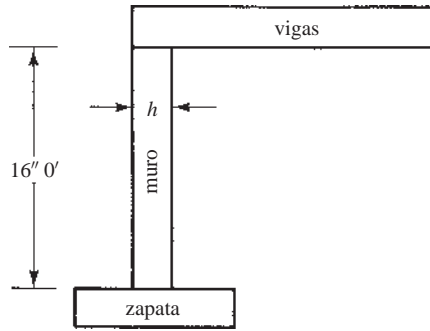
Muro empíricamente diseñado para el Ejemplo 18.1.
